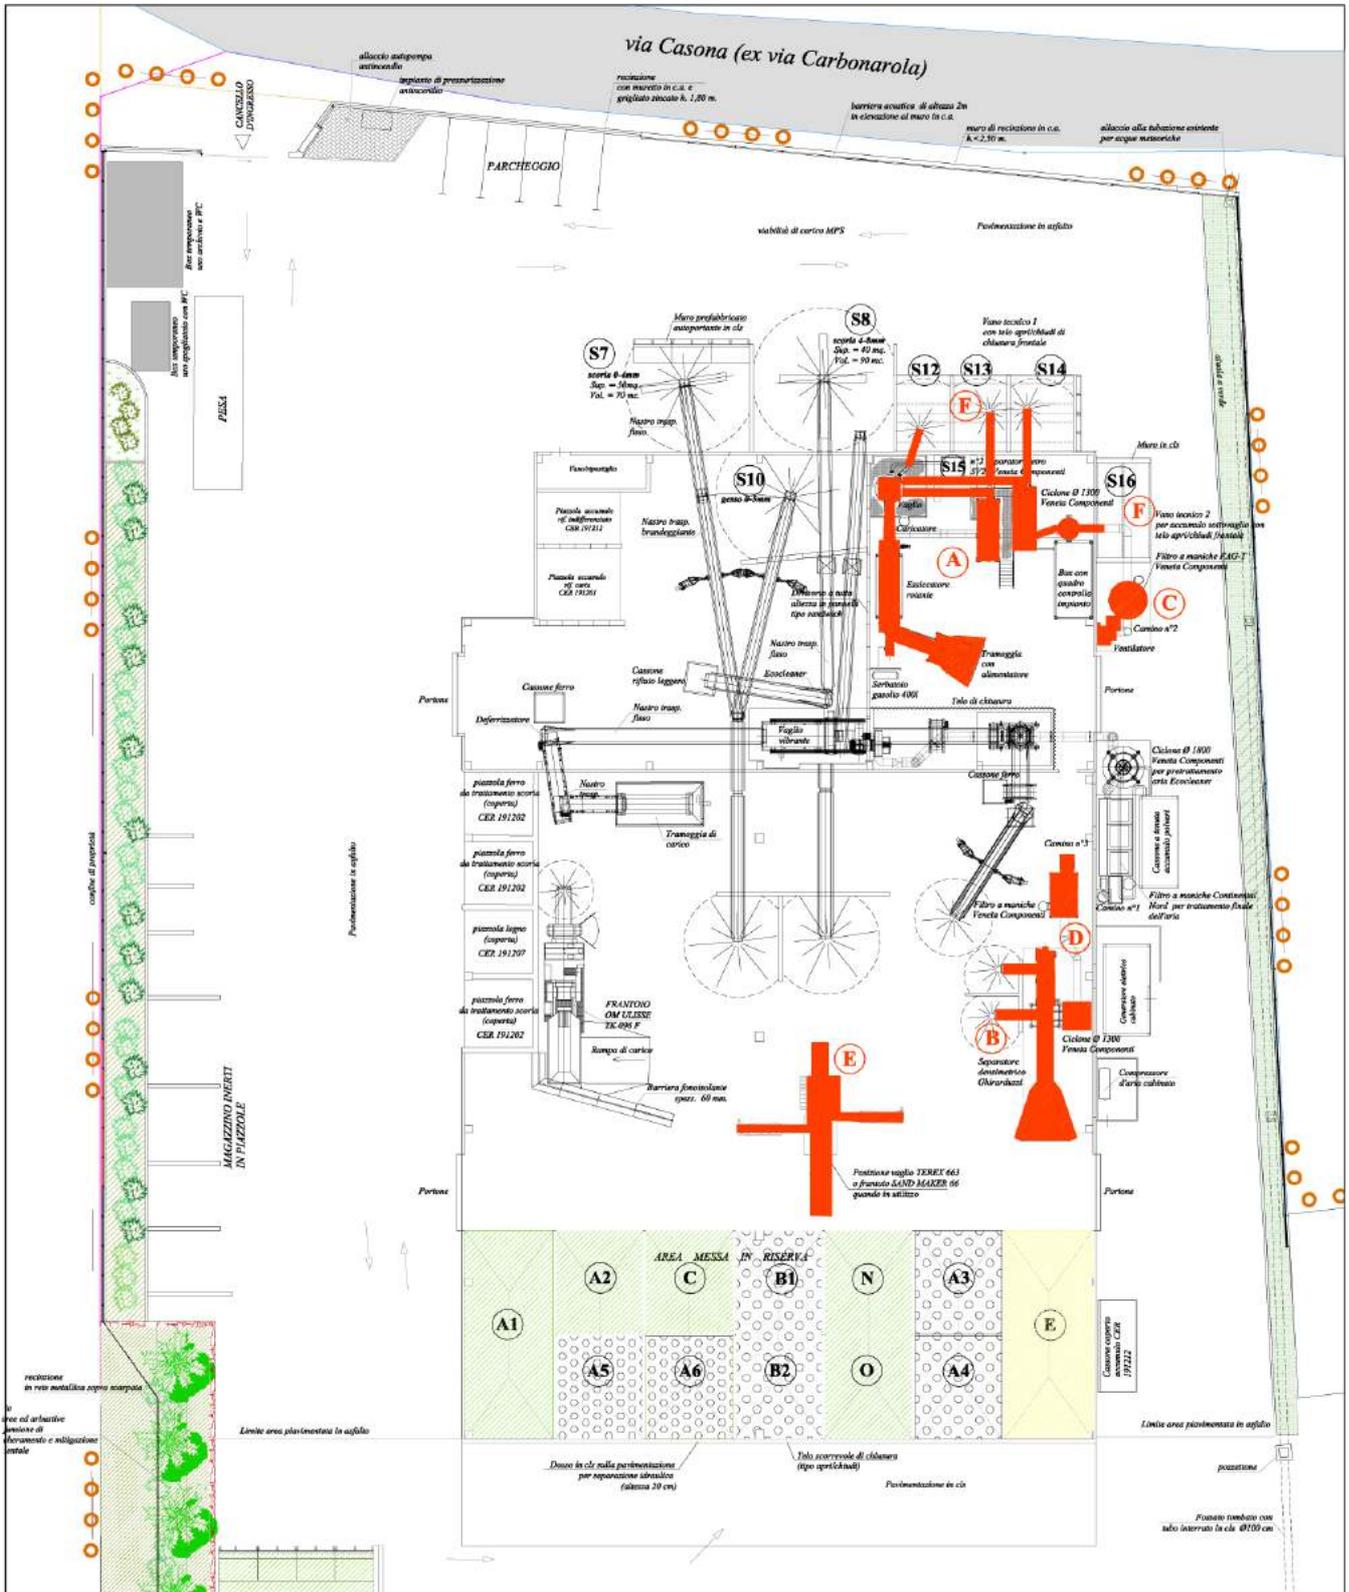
Planimetria del capannone dell'impianto di recupero con indicata l'ubicazione delle nuove sorgenti sonore
